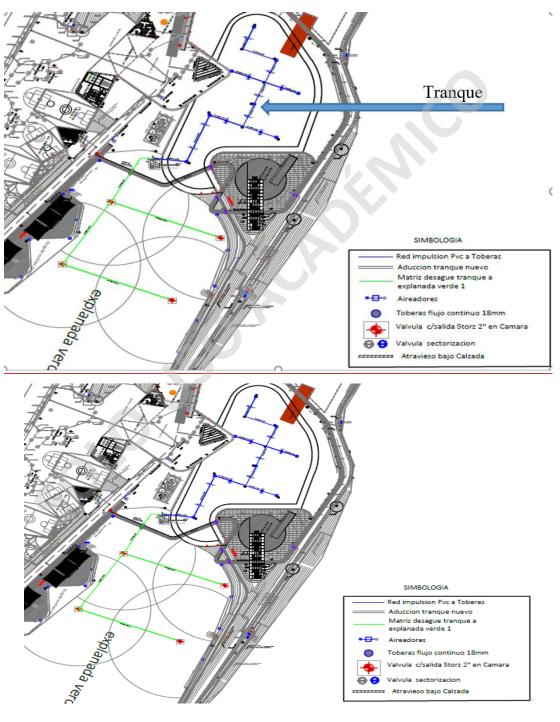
Plano Laguna, versión definitiva. Fuente: Ministerio de Vivienda y Urbanismo.
